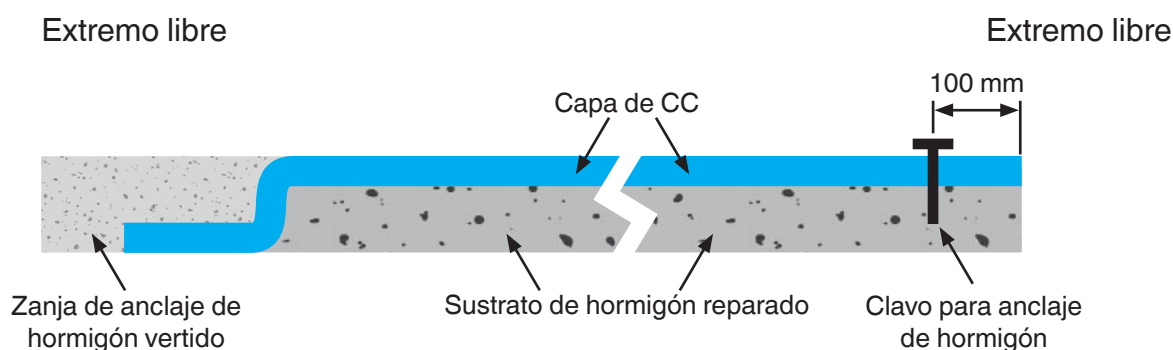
Instalación típica de una sección larga continua de CC sobre un extenso sustrato de hormigón. Cuando es necesario un anclaje, se puede utilizar una zanja de anclaje de hormigón vertido, o bien, clavos para anclaje de hormigón según corresponda.
